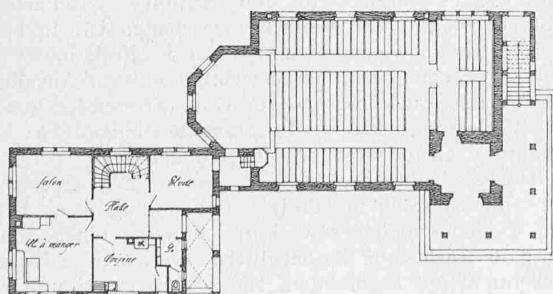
Kirche für Saignelégier. — Grundriss 1:400.
